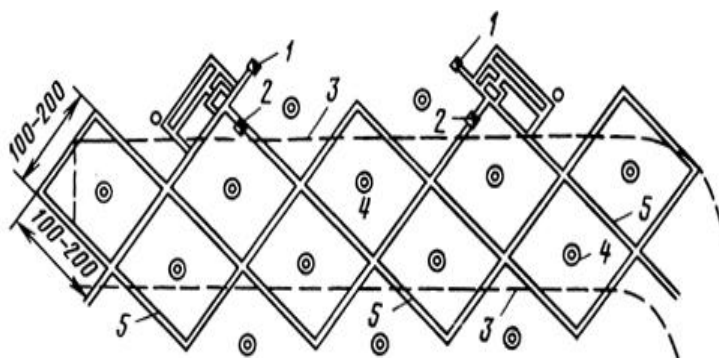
Схема подземного осушения (план): 1 — ствол дренажной шахты; 2 — вентиляционный шурф; 3 — контур разрезной траншеи; 4 — поглощающие колодцы; 5 — дренажные истреки. Размеры даны в метрах
